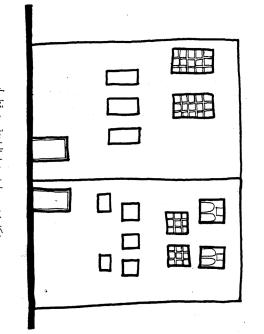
منزل مهدى عواصة الدور الأرضى – مسقط أفقى
